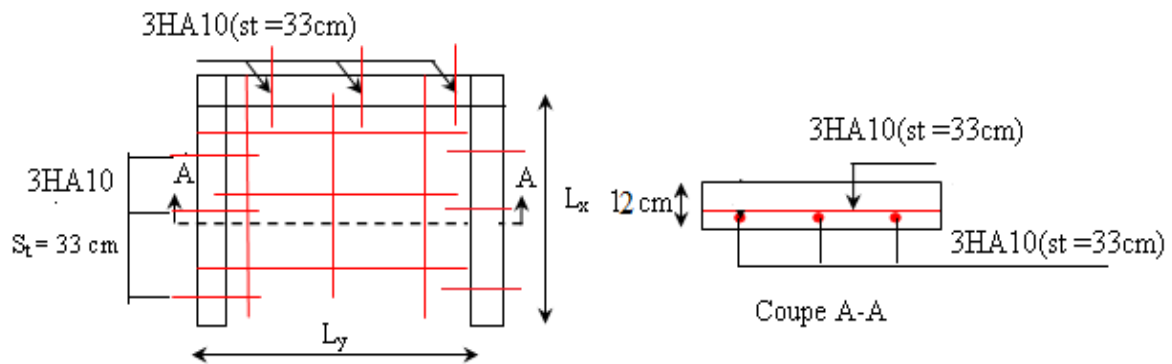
Schéma de ferrailage de la dalle D3, D6.
